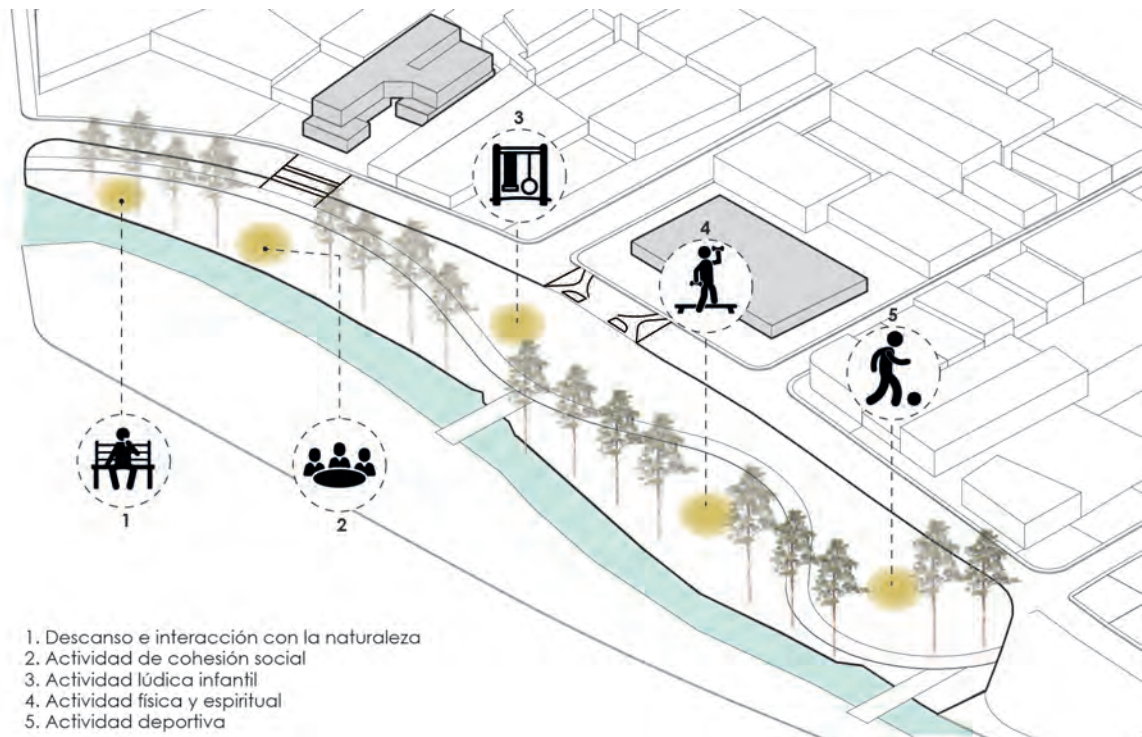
Planta Parque Lineal Río Tarqui núcleo 2,3 y 4
